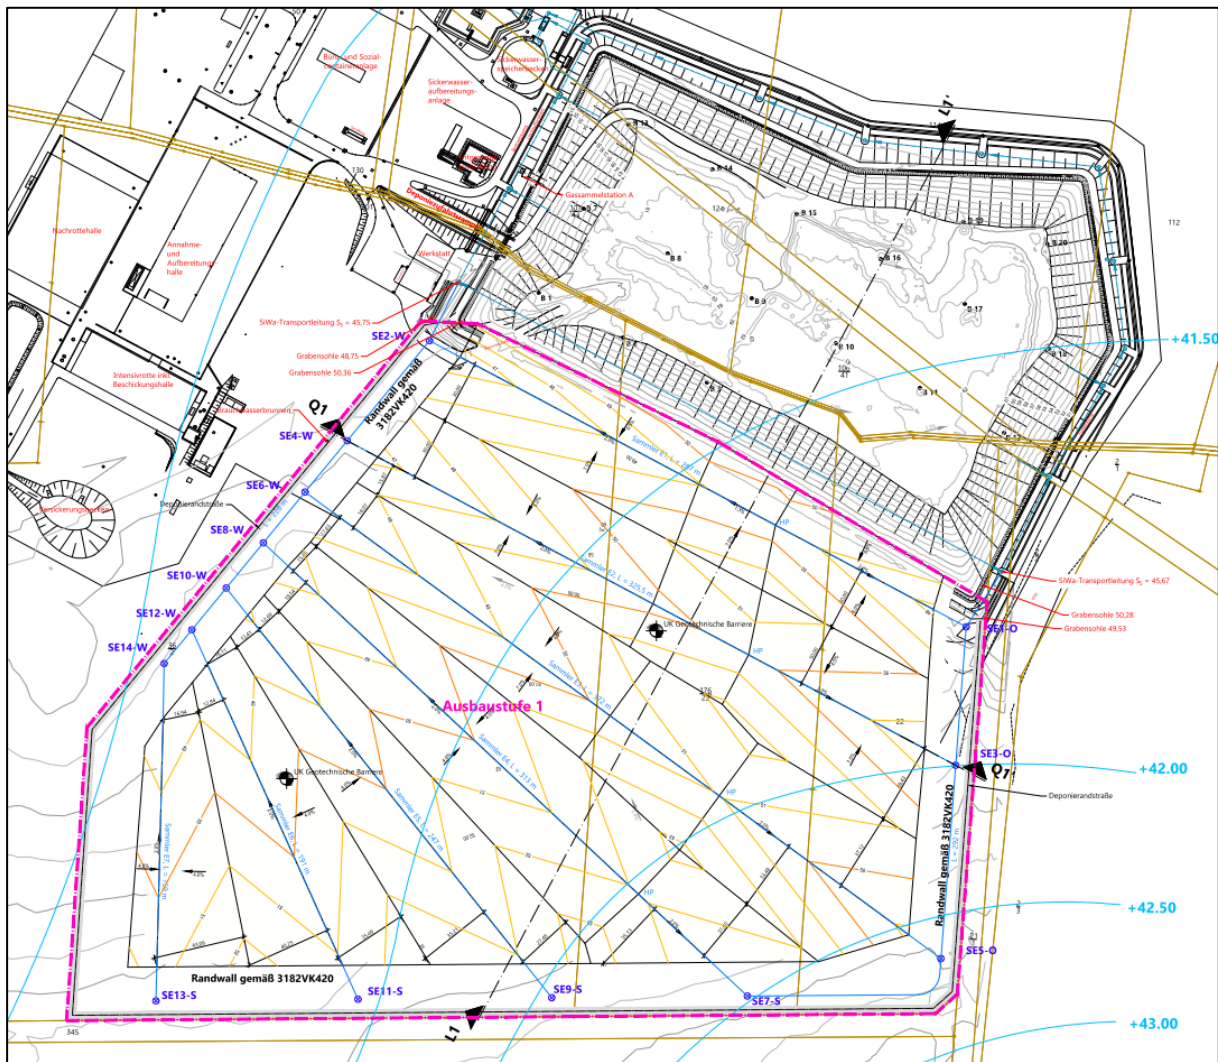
Ausschnitt aus dem Lageplan „OK Basisabdichtung“, aus [U1]
